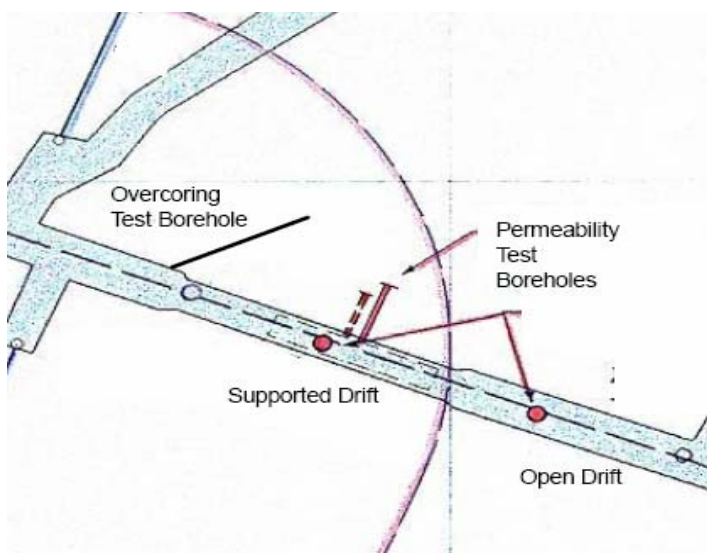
Grundriss der Dammjochstrecke und Lage der Messbohrungen, GRS (2001)
